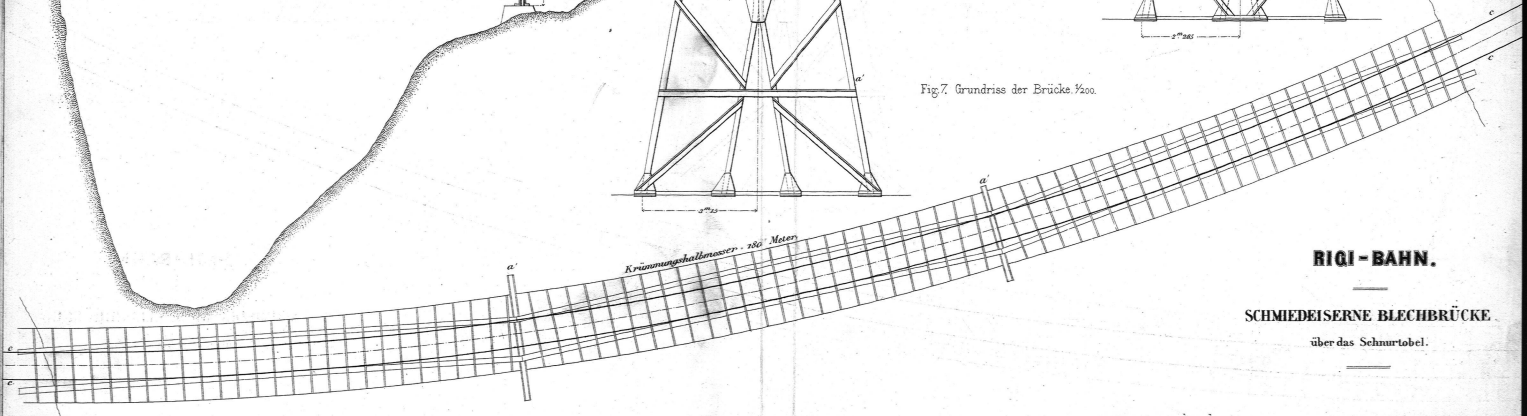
Grundriss der Brücke. 1/200.
